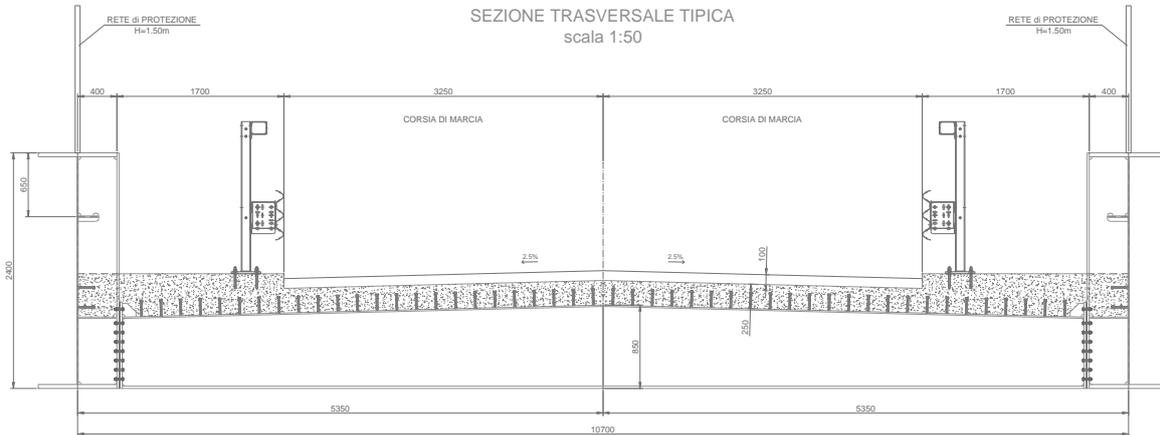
Sezione trasversale impalcato Cavalcavia Via Bassi
